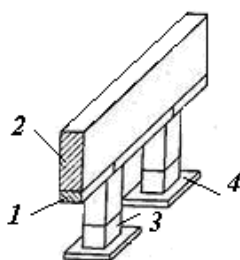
Стовпчасті фундаменти під несучі стіни: 1 – збірні елементи фундаменту; 2 – несуча стіна; 3 – збірні елементи фундаменту; 4 – фундаментна плита
